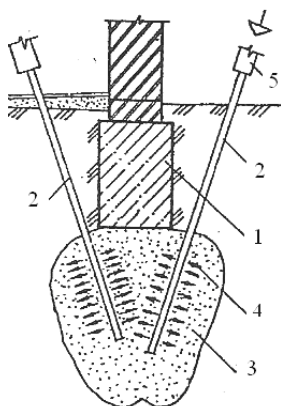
Химическое закрепление грунтов нагнетанием в основание фундаментов растворов (силикатизация, смолязация):
